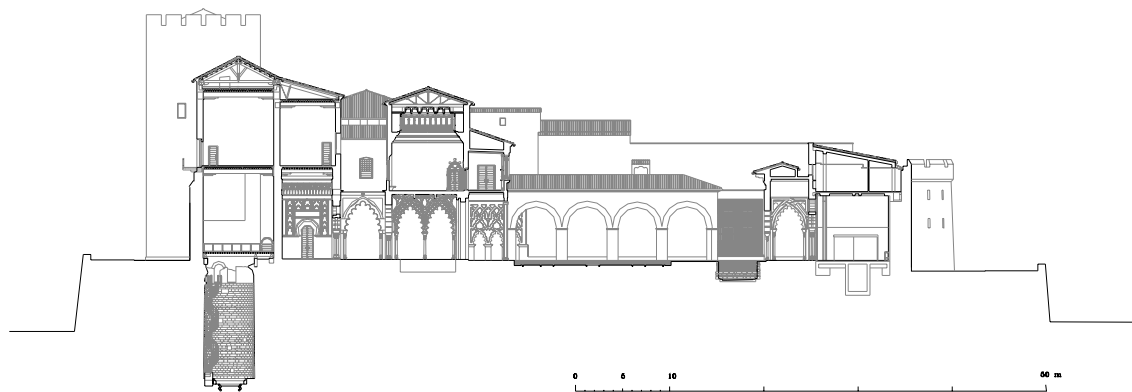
Planimetría actual del recinto completo. Sección longitudinal por el Patio de Santa Isabel (Dibujo de L. Franco y M. Pemán)
